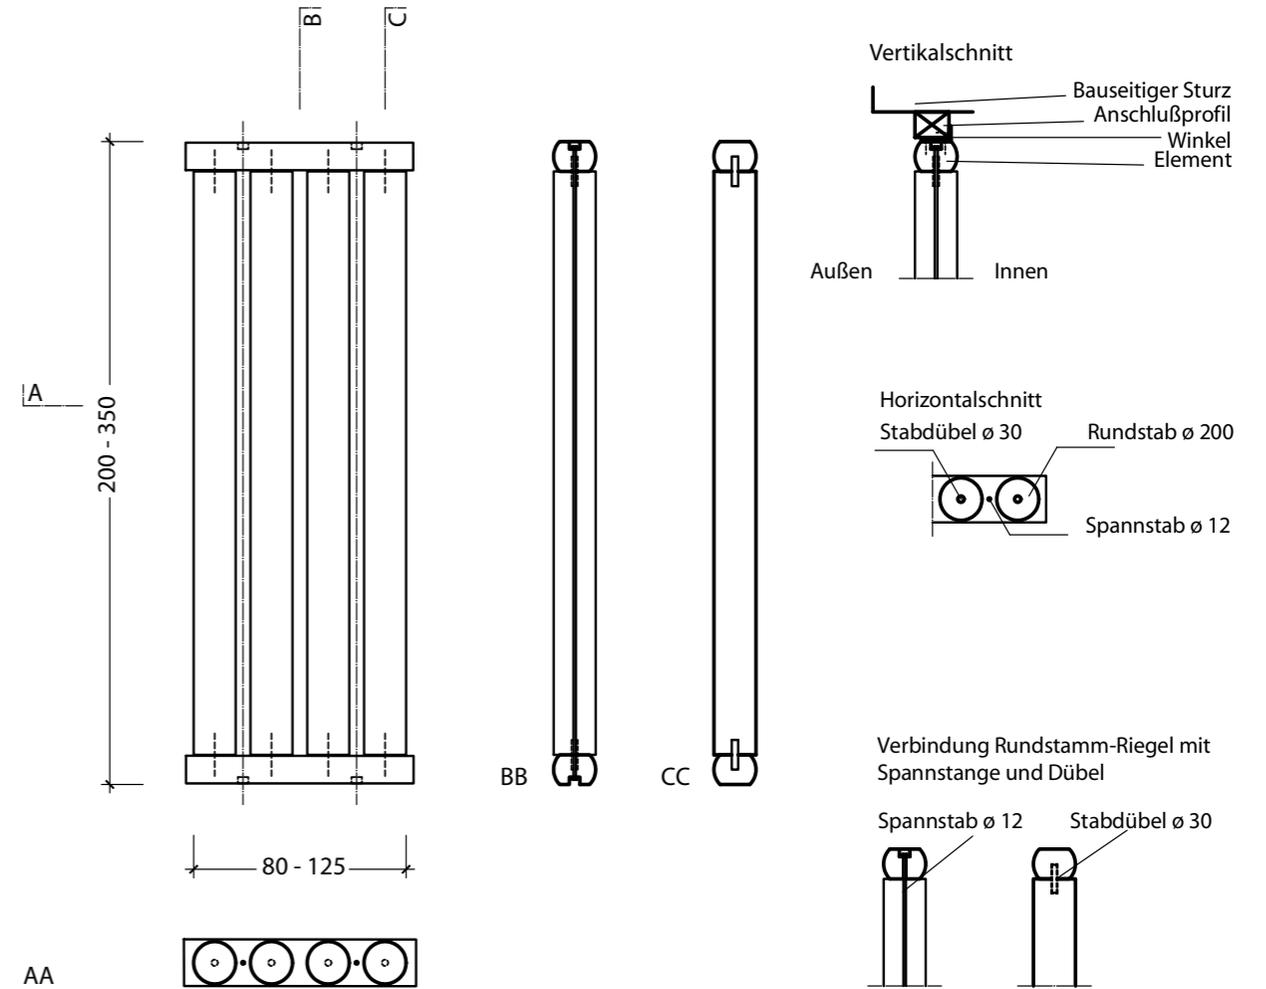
Studie Fassadenelement Rundstamm vorgespannt
